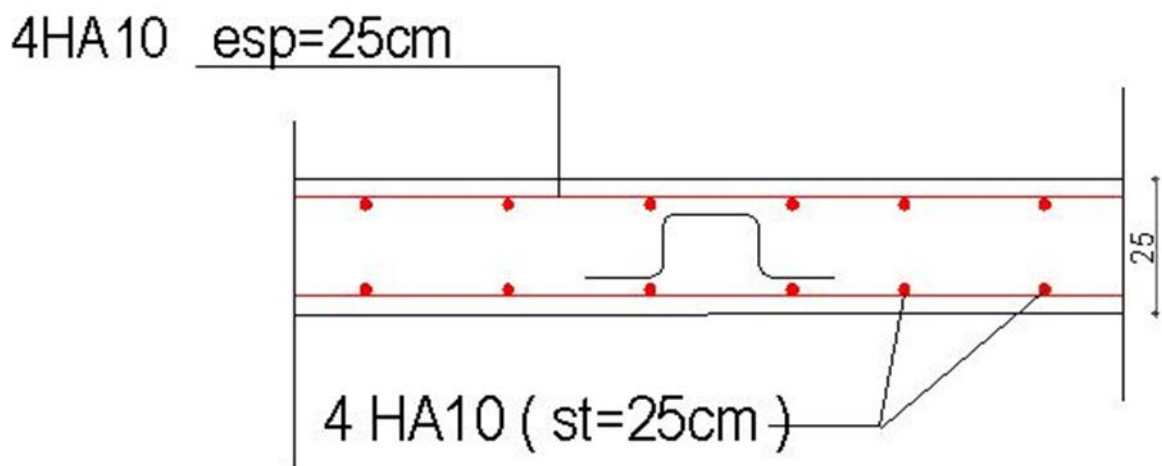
Plan de ferrailage de la salle machine suivant x-x.
